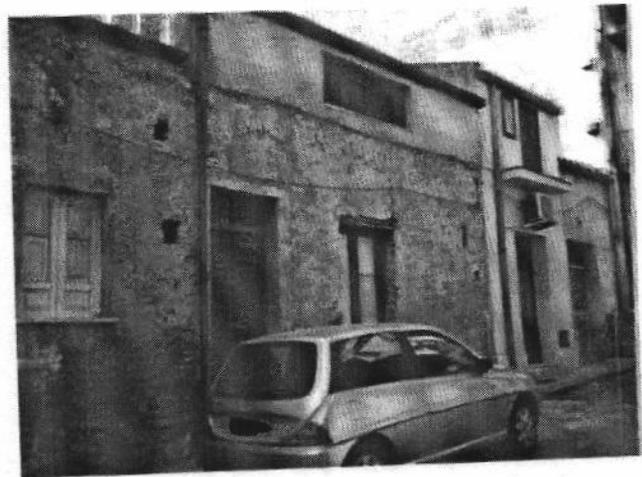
Ingresso secondario su via Gen. Cascino.
